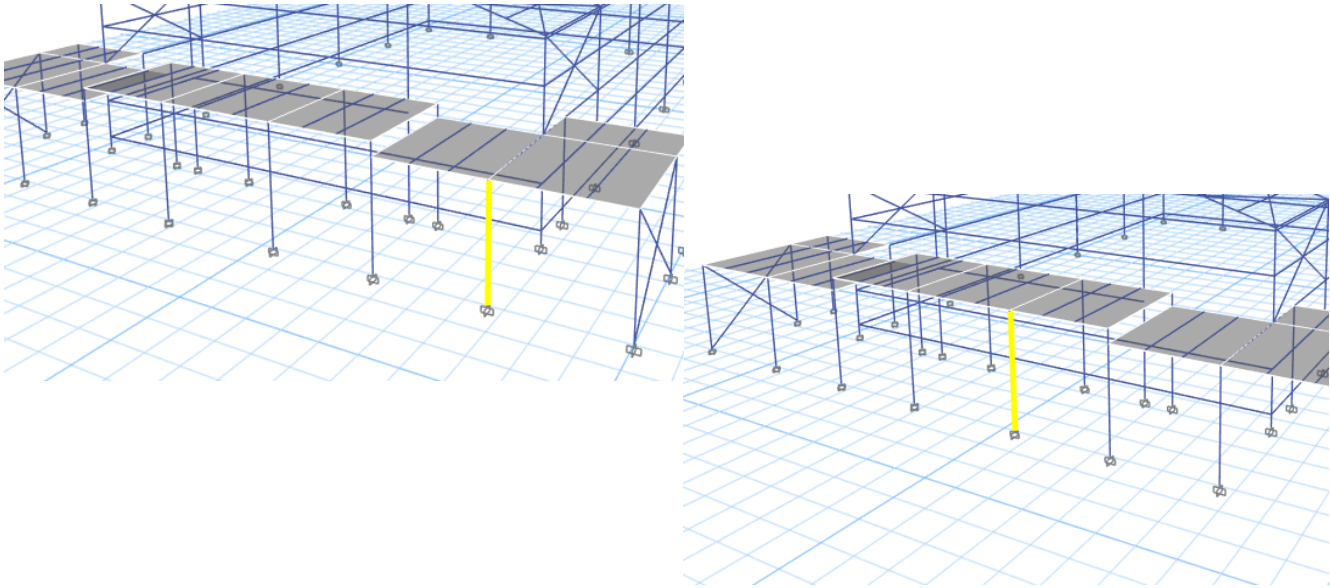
Les poteaux HEA220 de 4.3 et 3.8m.
